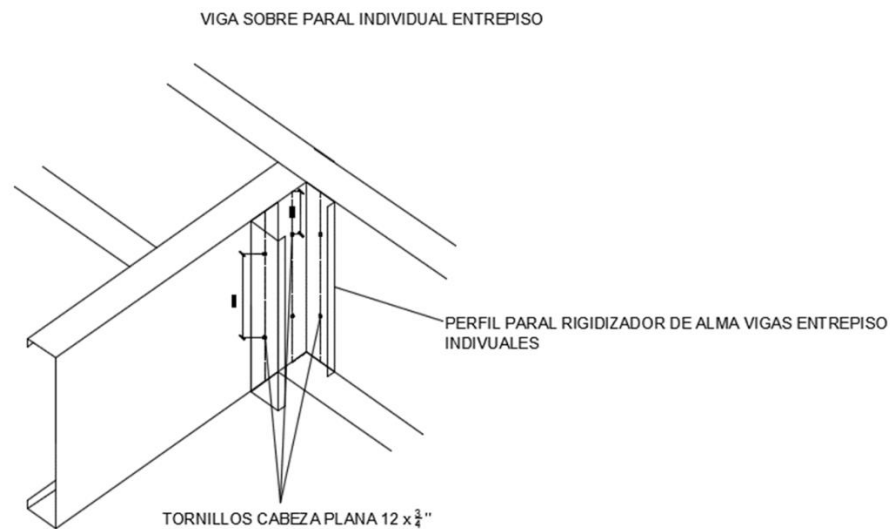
Detalle del rigidizador de apoyo para vigas individuales de entrepiso, por los autores, 2020.
